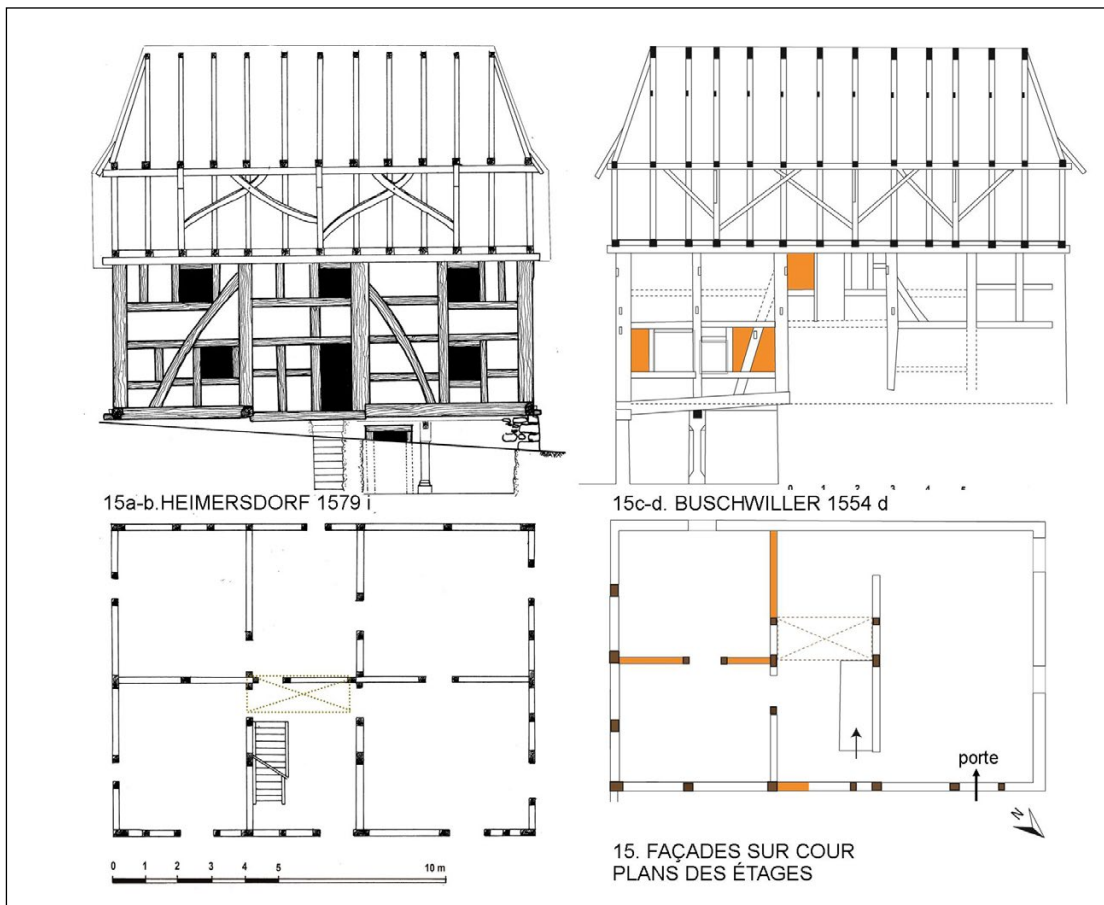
A-B-C-D : Façade sur cour et plan de l'étage de la maison de Buschwiller comparés à ceux de Heimersdorf (maison détruite). L'organisation interne et sa traduction en façade sont identiques. Contrairement au rez-de-chaussée, l'étage de la travée avant est divisé en deux pièces égales séparées par un mur en pan de bois et torchis.
